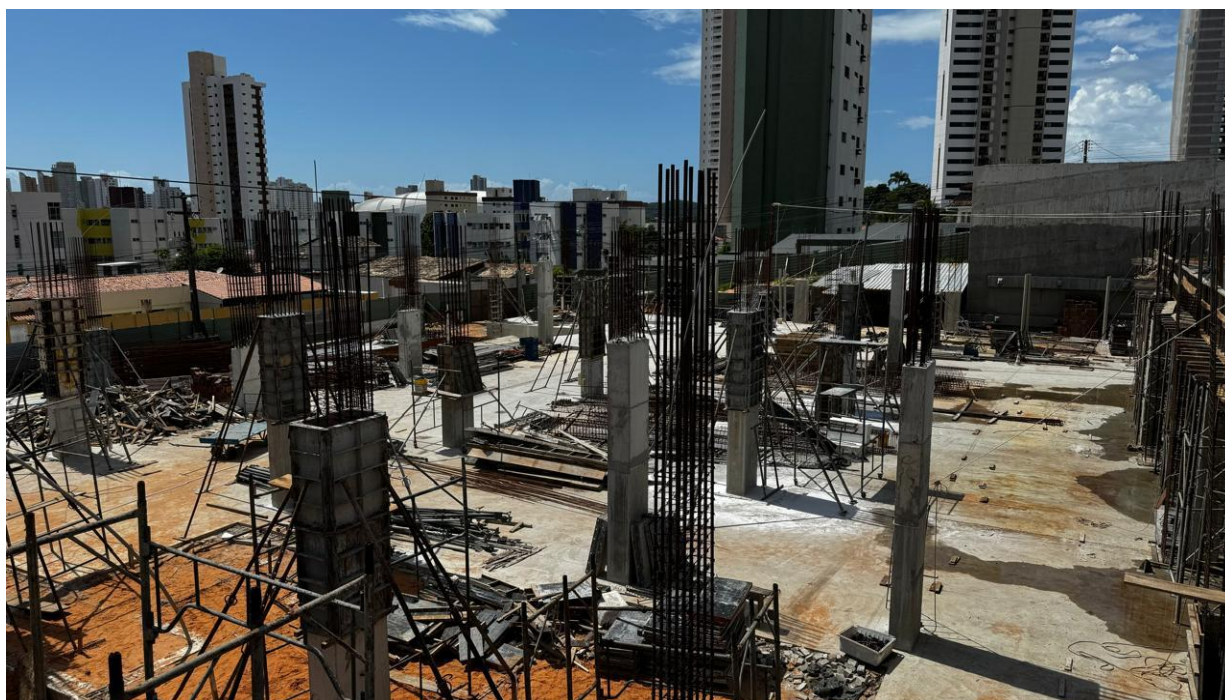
Montagem das formas dos pilares do segundo subsolo na segunda etapa da concretagem.
